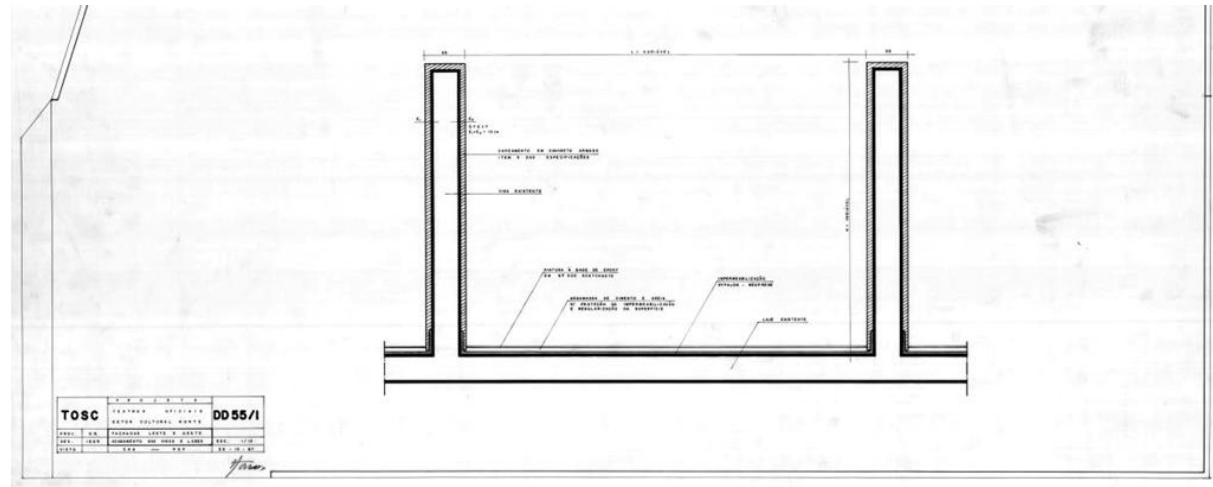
Corte Transversal/Detalhe (1967). Carimbo: Teatros Oficiais no Setor Cultural Norte, TOSC, DD 55/1. Conteúdo: Fachadas leste e oeste, acabamento das vigas e Lajes. Desenho: Igor. Data: 25/10/1967. Fonte: ARPDF.
